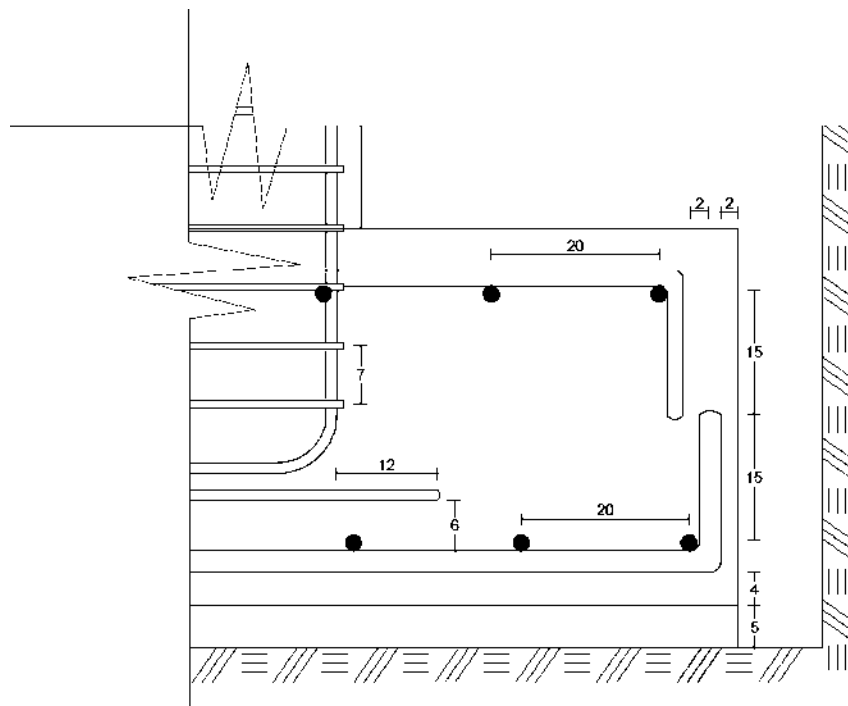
(c) Detallado de la zapata en dirección longitudinal de la estructura, (cm)
